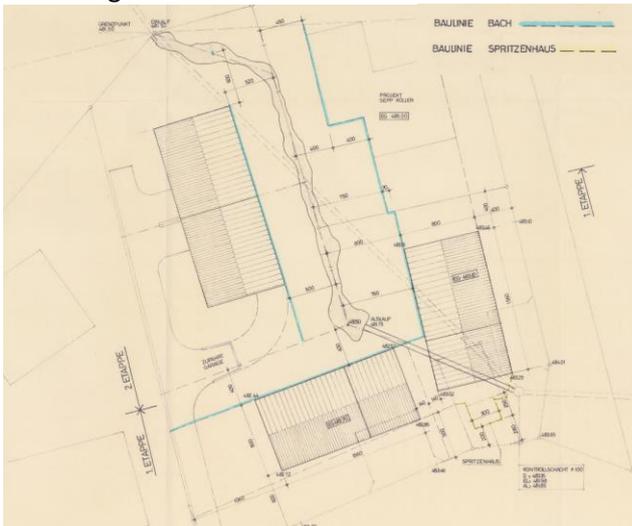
Planausschnitt BLP 'Unteroppikon-Ost' 1993
